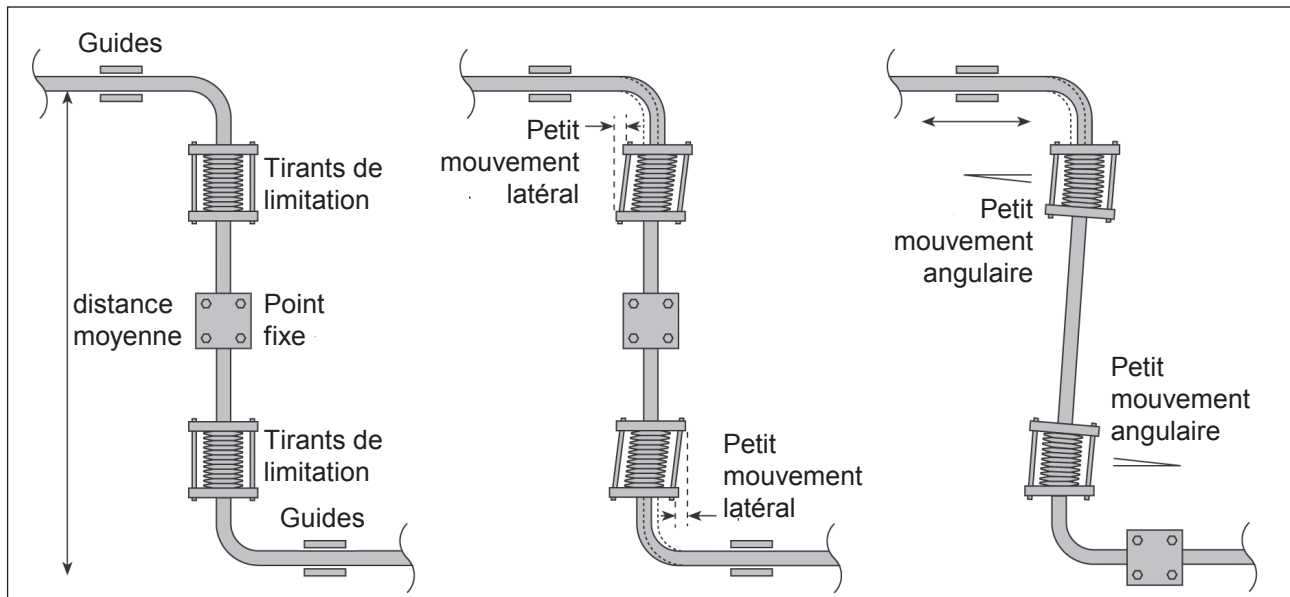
Petit mouvement latéral et angulaire de soufflets
